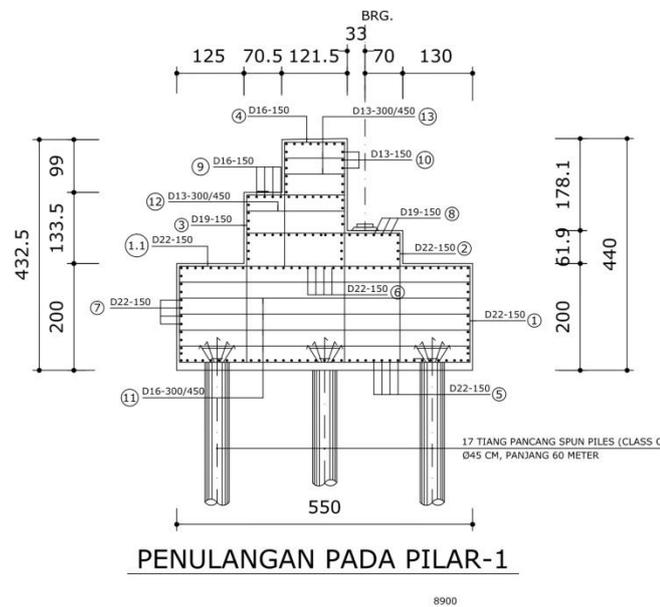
6 Tampak Melintang Tiang Pancang Beton
